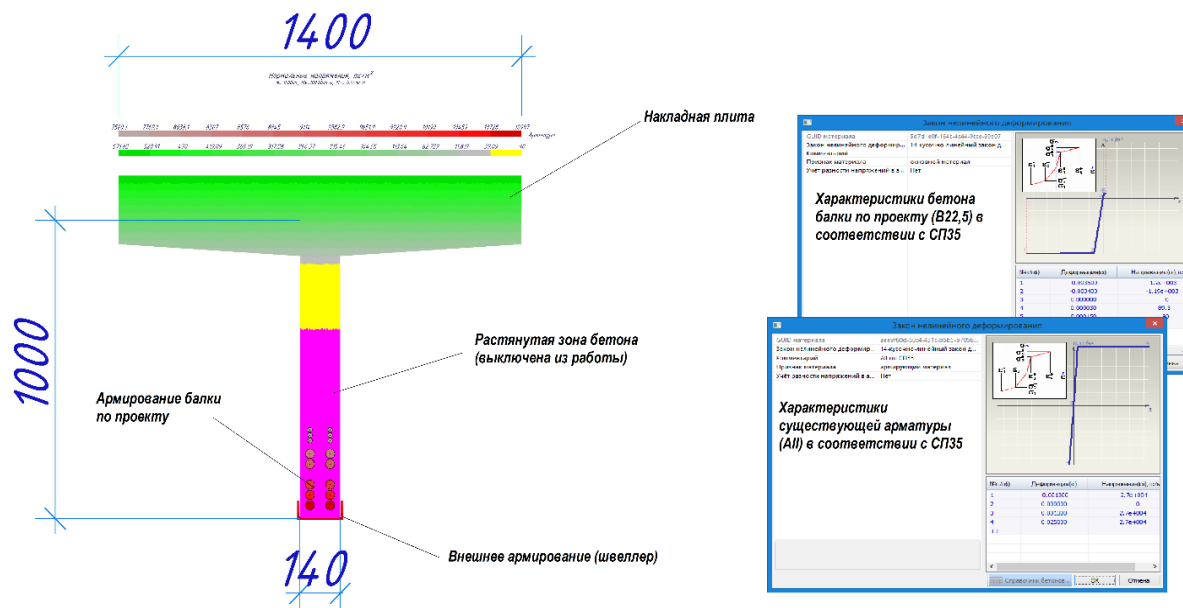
Схема поперечного сечения каркасной балки, усиленной накладной плитой
